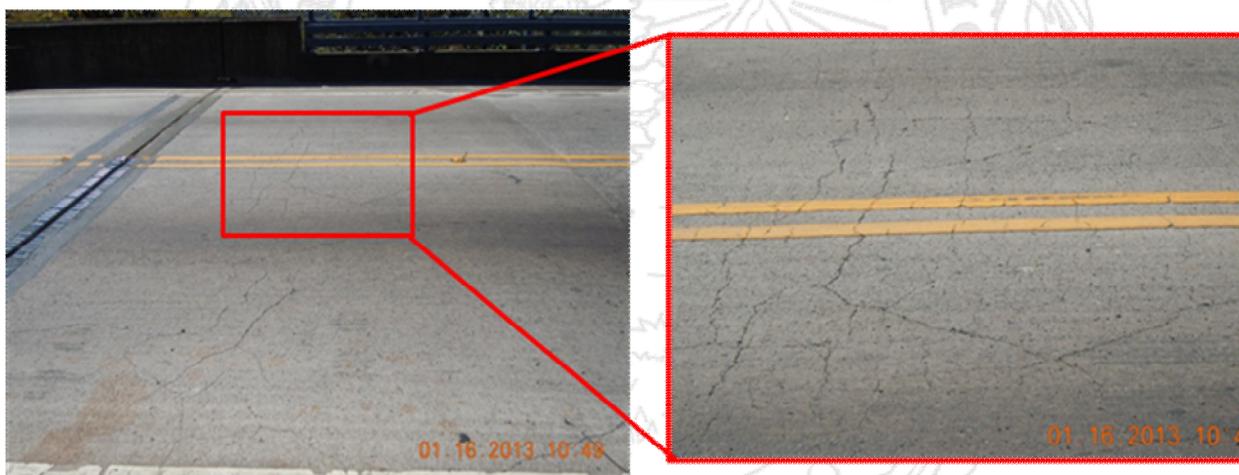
Agrietamiento principalmente transversal (con espesor mayor a 0,20mm) de sección de losa adyacente a la junta de expansión sobre el bastión este.
